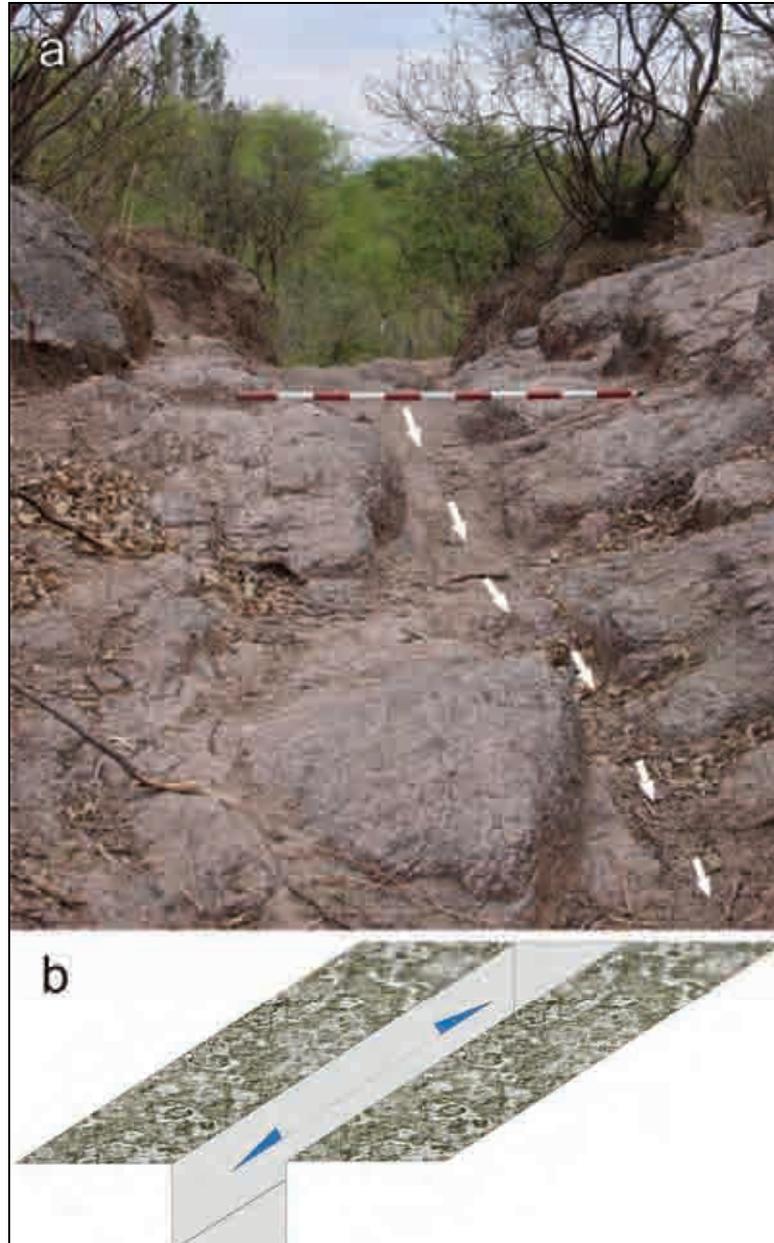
a) Segmento de camino labrado sobre roca granítica. Las flechas indican el sistema de drenaje central abierto. Fotografía del autor. b) Esquema de “sistema de drenaje paralelo abierto revestido de rocas en el centro del camino”, tomado y modificado de Vitry (2004a: 19, figura 10-F)
